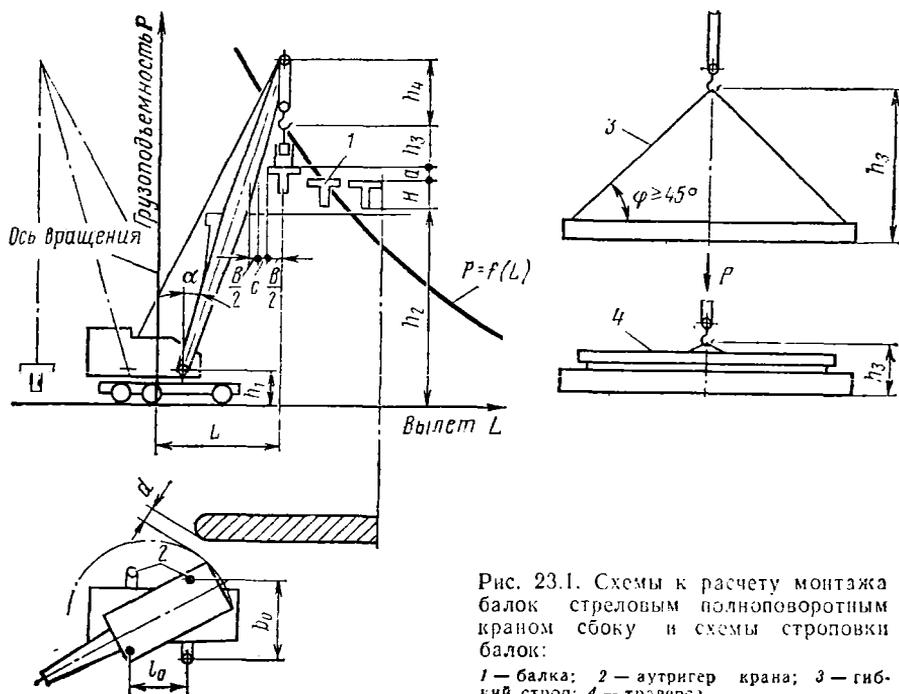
Схемы к расчету монтажа балок стреловым полностью поворотным краном сбоку и схемы строповки балок:
